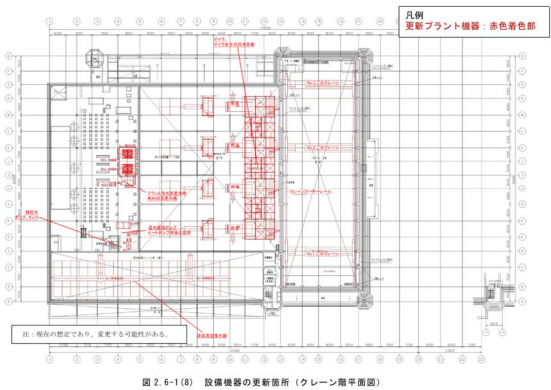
(8) 設備機器の更新箇所 (クレーン階平面図)
